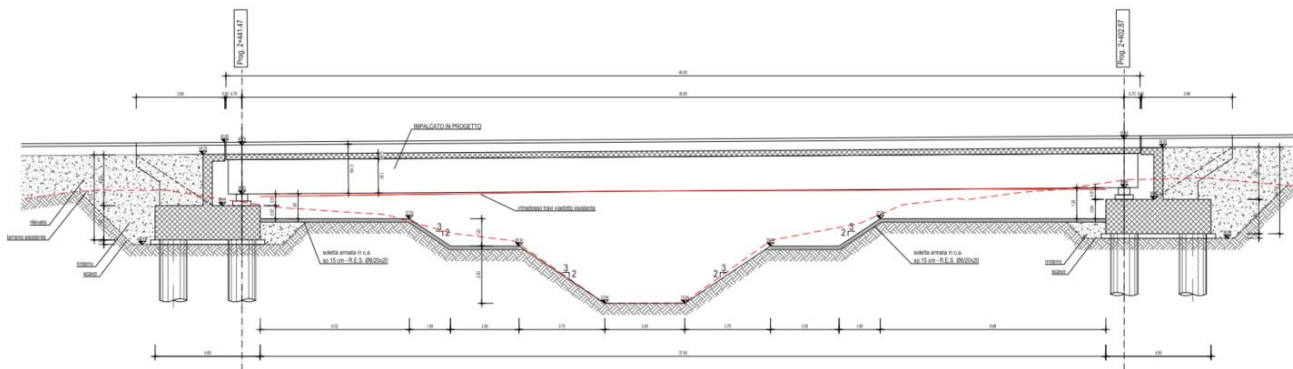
PROSPETTO DEL PONTE IN PROGETTO SUL CANALE MACINANTE
